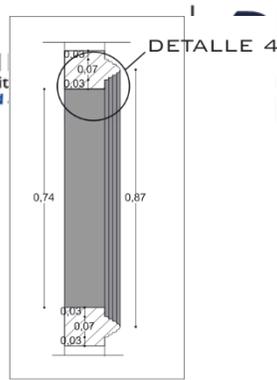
Sección E-E, detalle rosetón, Estación del ferrocarril Sur.
